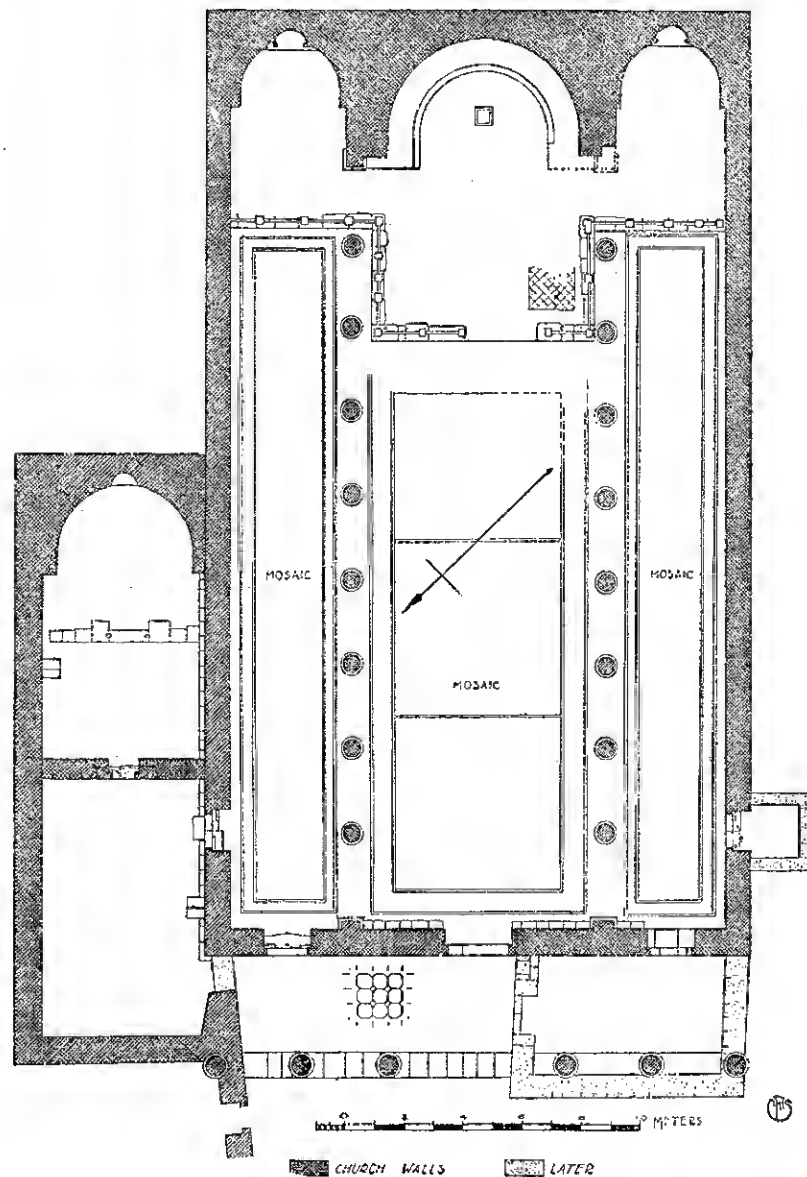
Gerasa, basilique de Sts Pierre et Paul. Plan (d'après J. Crowfoot).
